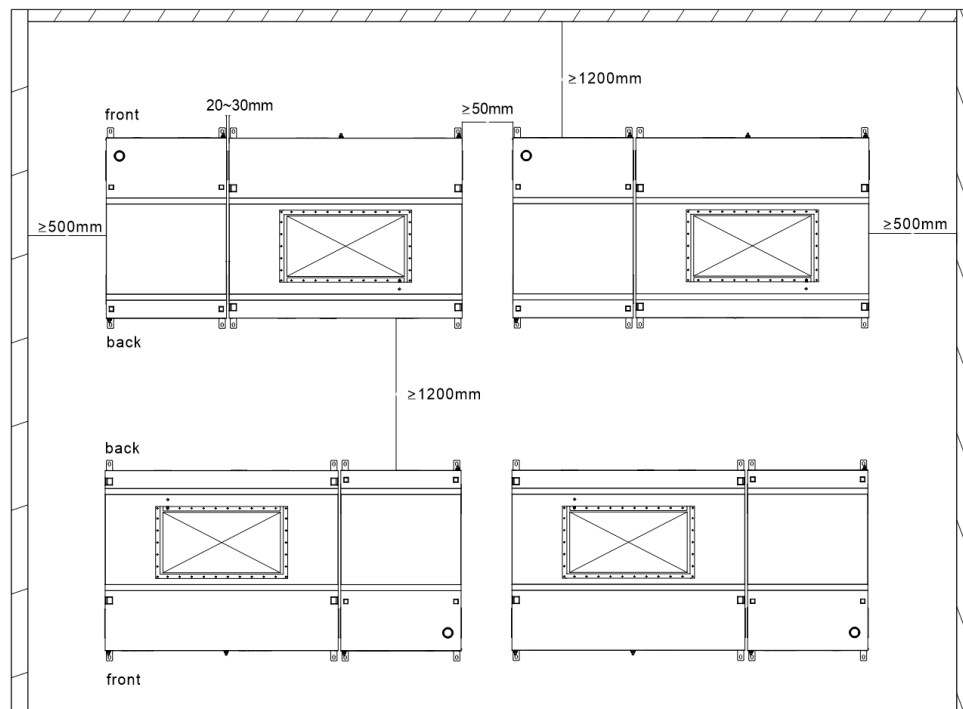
Rücken-an-Rücken-Montage (Draufsicht)
